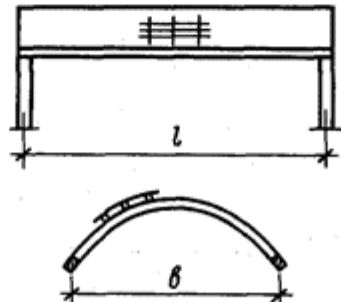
Схеми просторових дерев'яних конструкцій:
